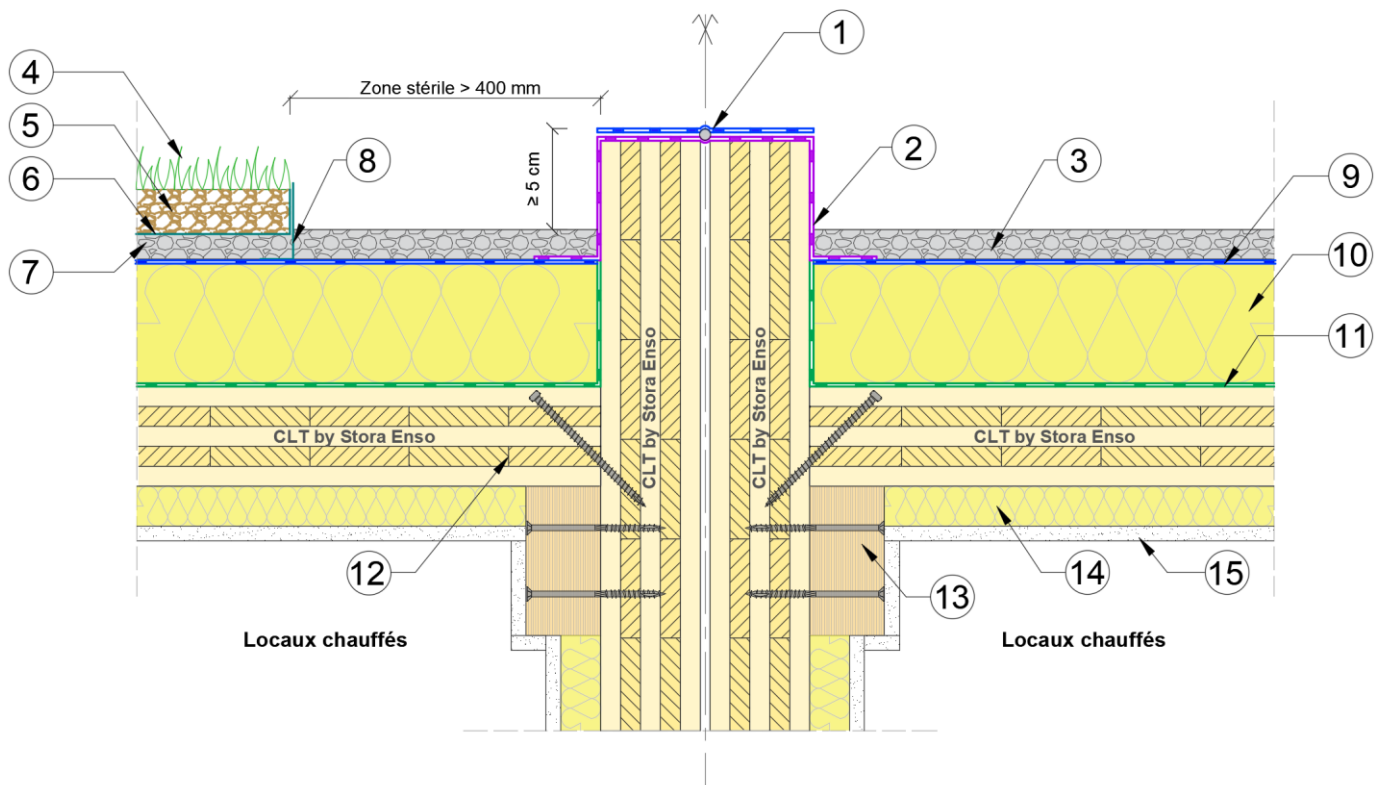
Exemple de traitement d'un relevé en configuration de toiture inaccessible isolée sur bâtiment chauffé avec isolation support d'étanchéité – Acrotère rapporté en CLT by Stora Enso avec isolant de relevé - Coupe perpendiculaire à la pente.
